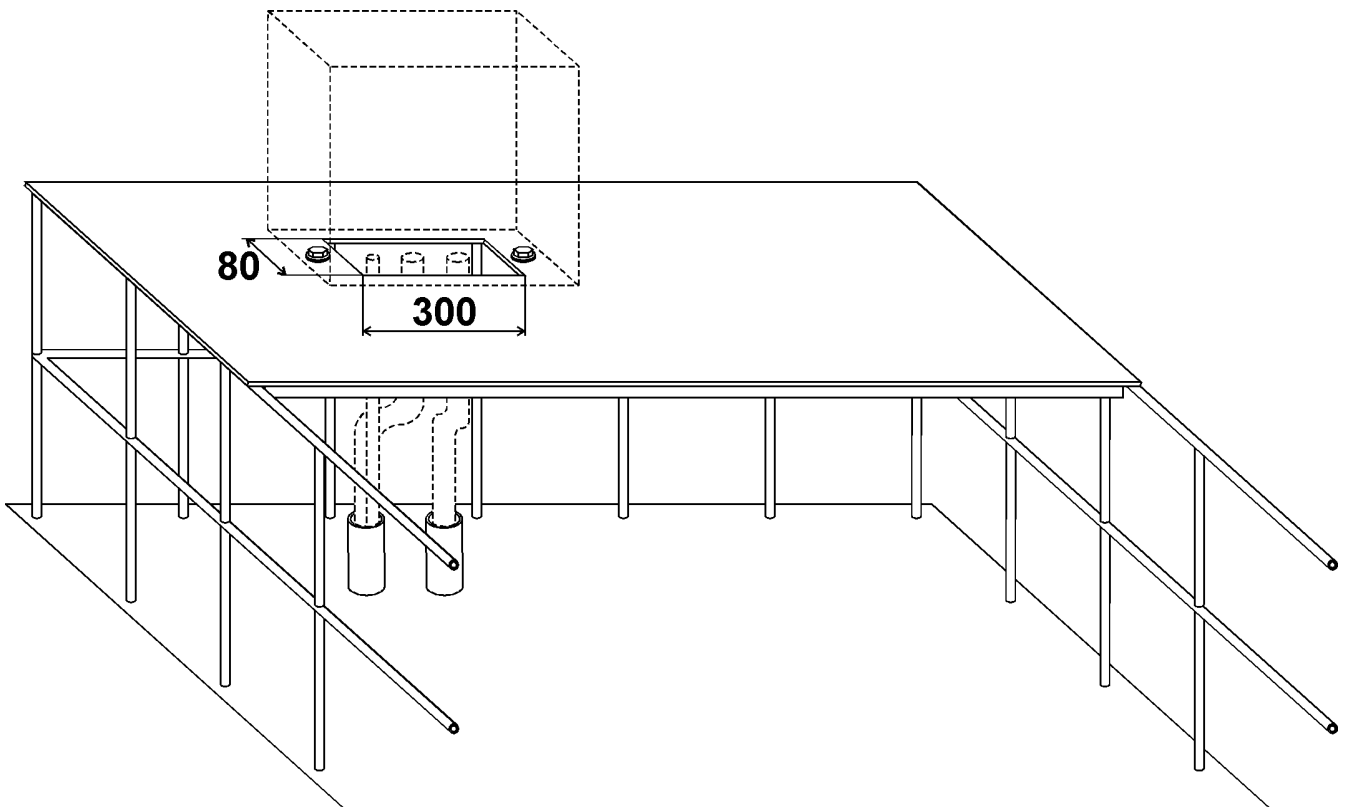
Вариант установки блока УМП на ограждение смотровой площадки.
